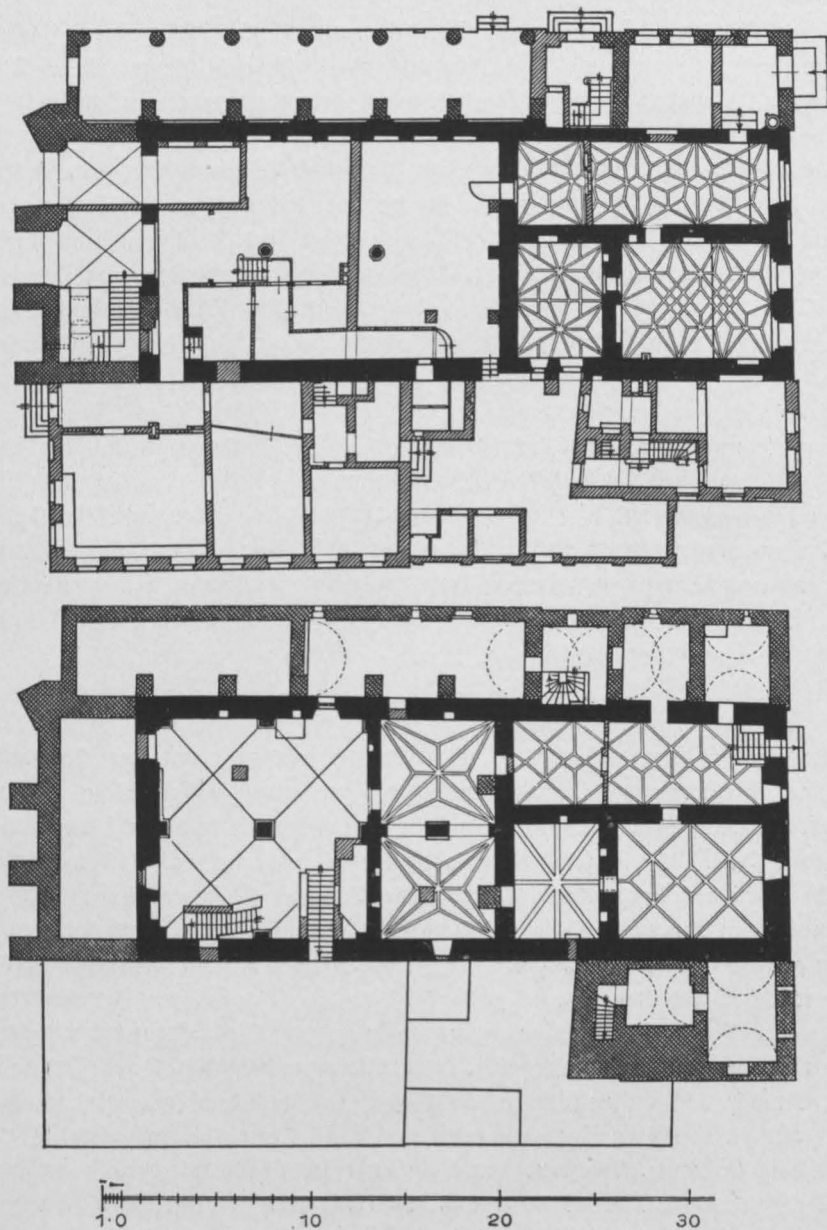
Lückau. Grundrisse des Rathauses.
